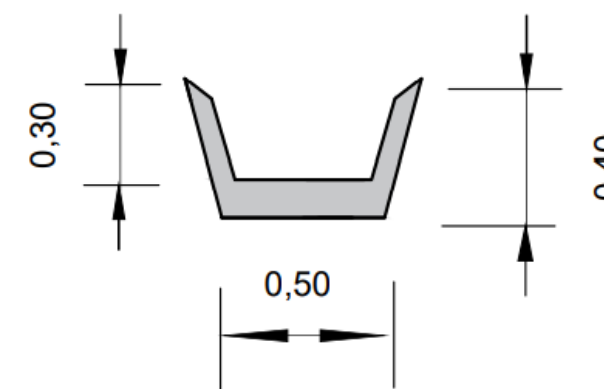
Sección cuneta de berma. Fuente: Elaboración propia.
